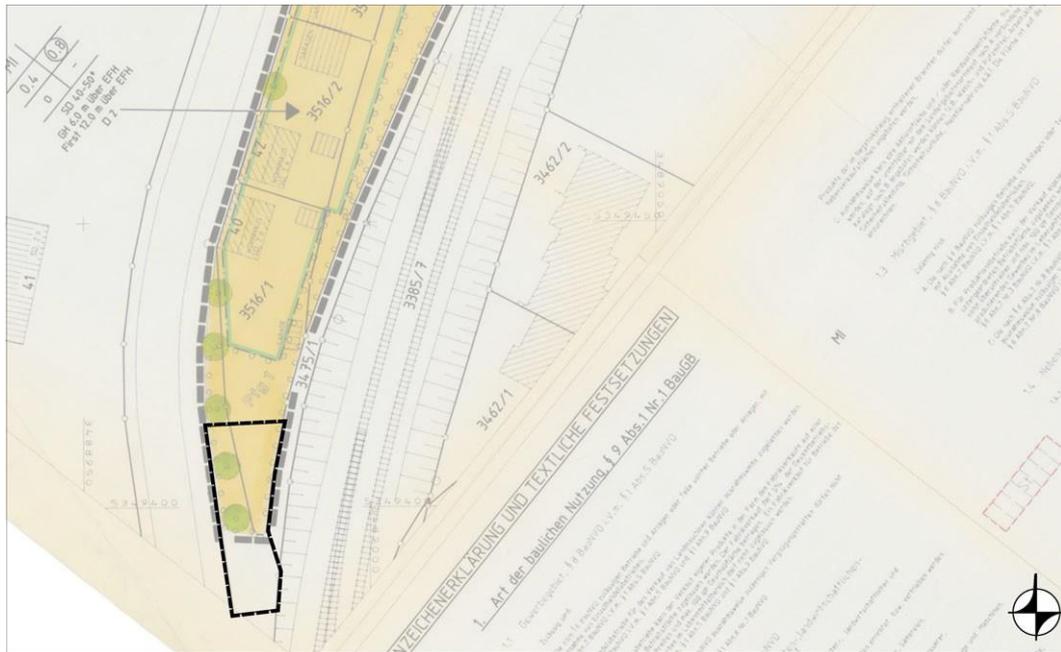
Überschneidung Geltungsbereich mit Bebauungsplan "Raiffeisenmarkt"
